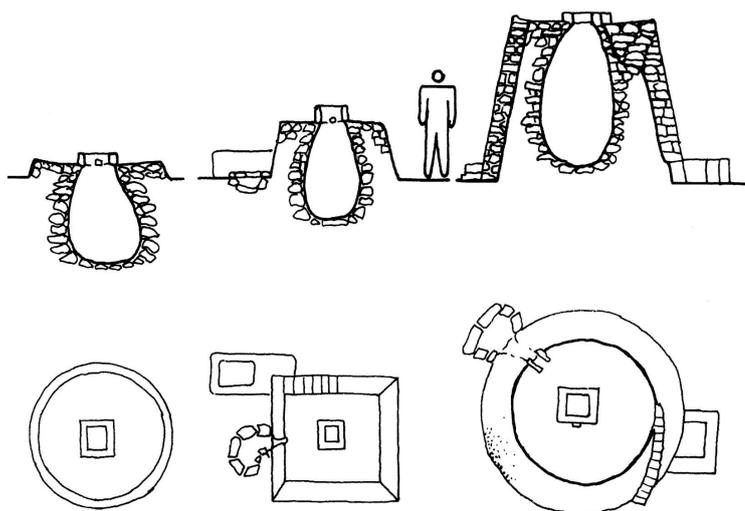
Cisterne costruite con diverso rapporto rispetto al piano campagna, viste in sezione e dall'alto. Tratto da "Architetture in pietra a secco nel Salento" di G. Grasso.
